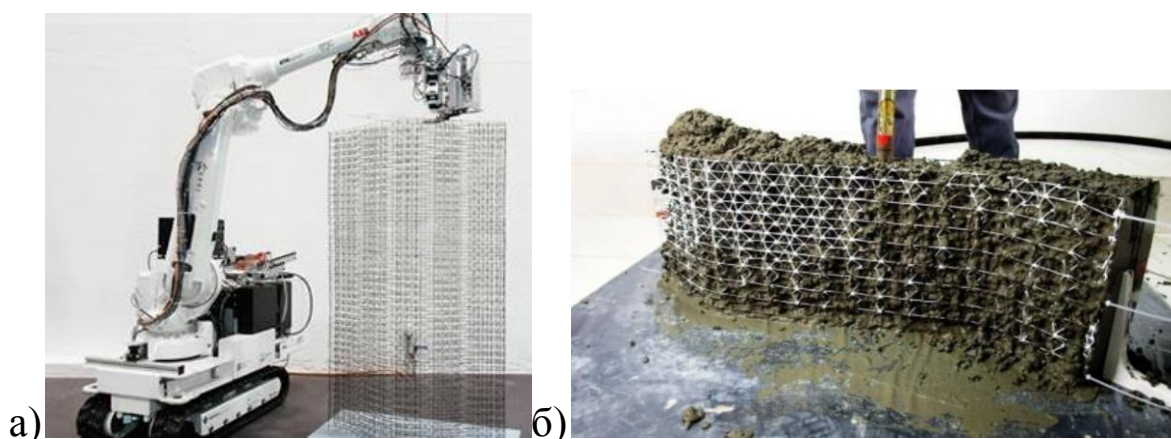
Проект Mesh Mould: а – создание стального арматурного каркаса [2]; б – процесс укладки бетонной смеси [3]
